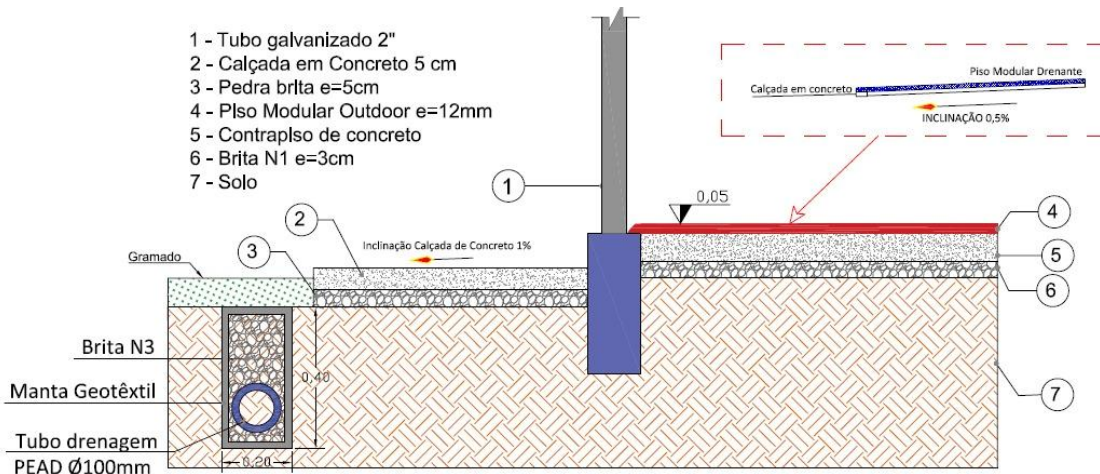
Detalhe de instalação Drenagem (Fonte: Autor/2025)
